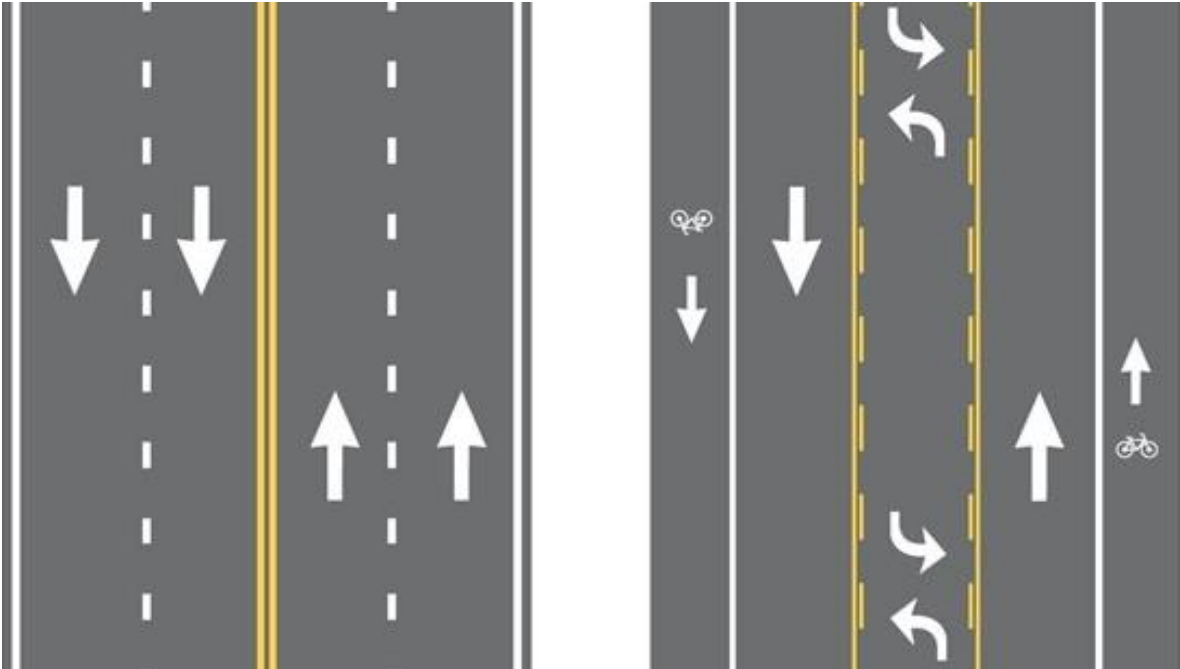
Estrechamiento de calzadas. Antes (izquierda), después (derecha). Elaboración: (FHWA, 2014)
